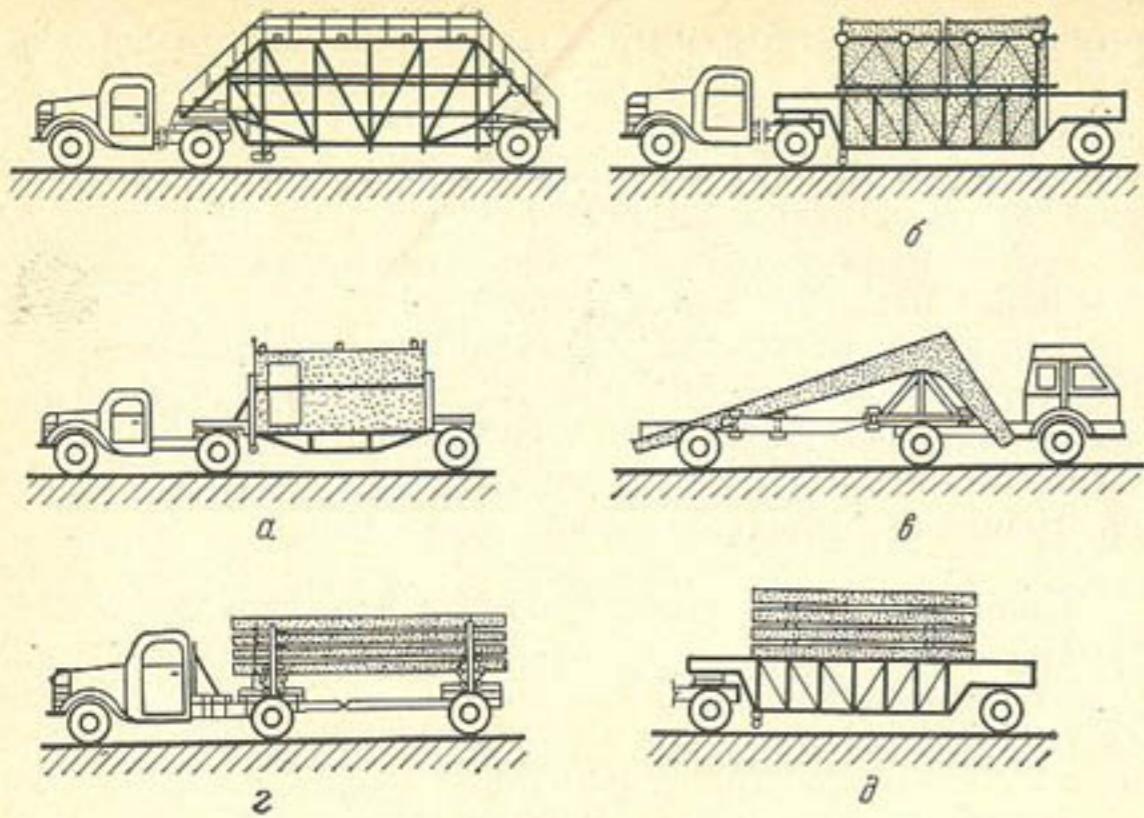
Автомобильный транспорт, используемый для перемещения строительных изделий и конструкций:
